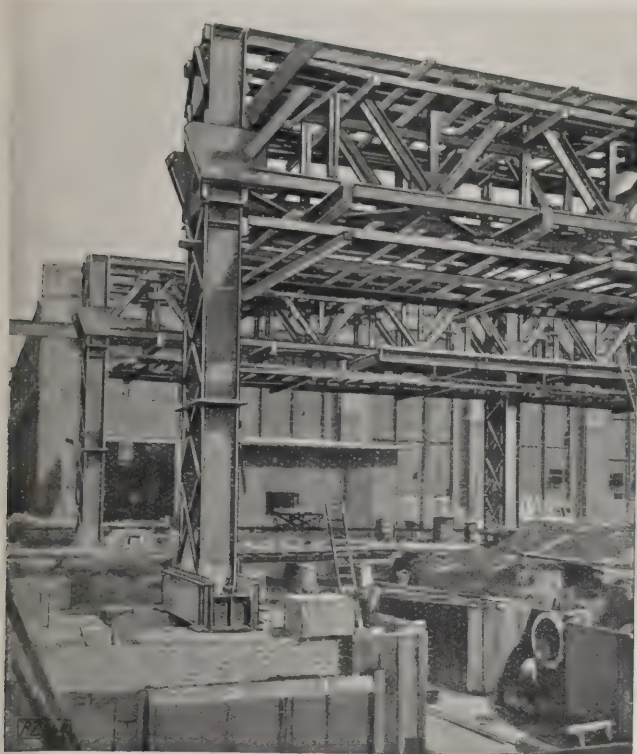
Heizkelleranlage mit Grundwasserverdichtung.
